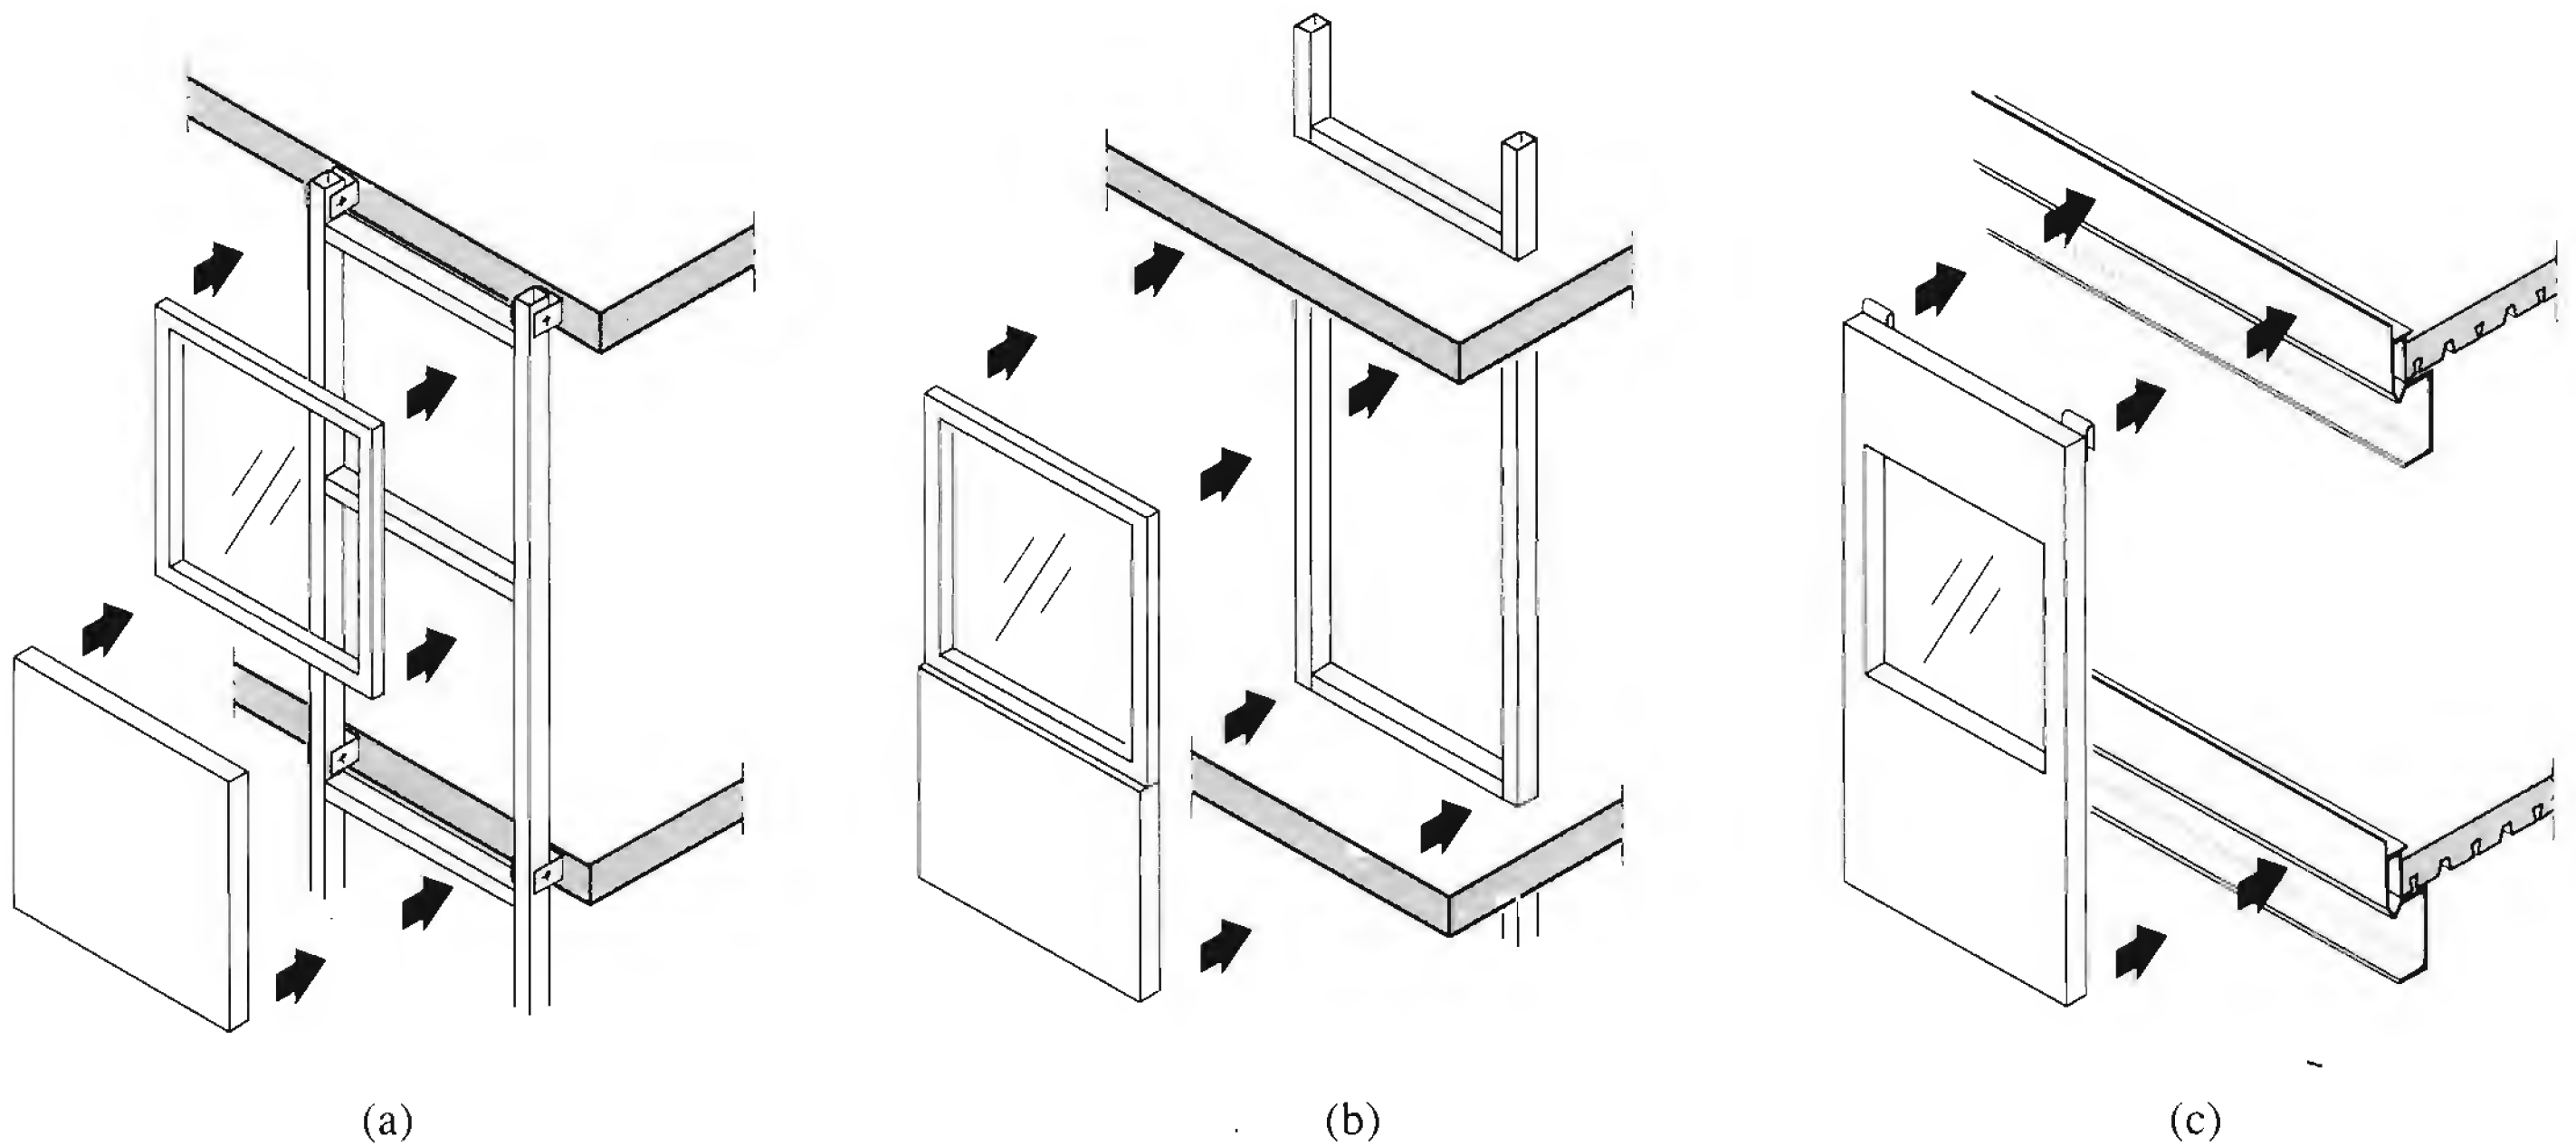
Façades montées sur grille, sur montants ou en panneaux.
